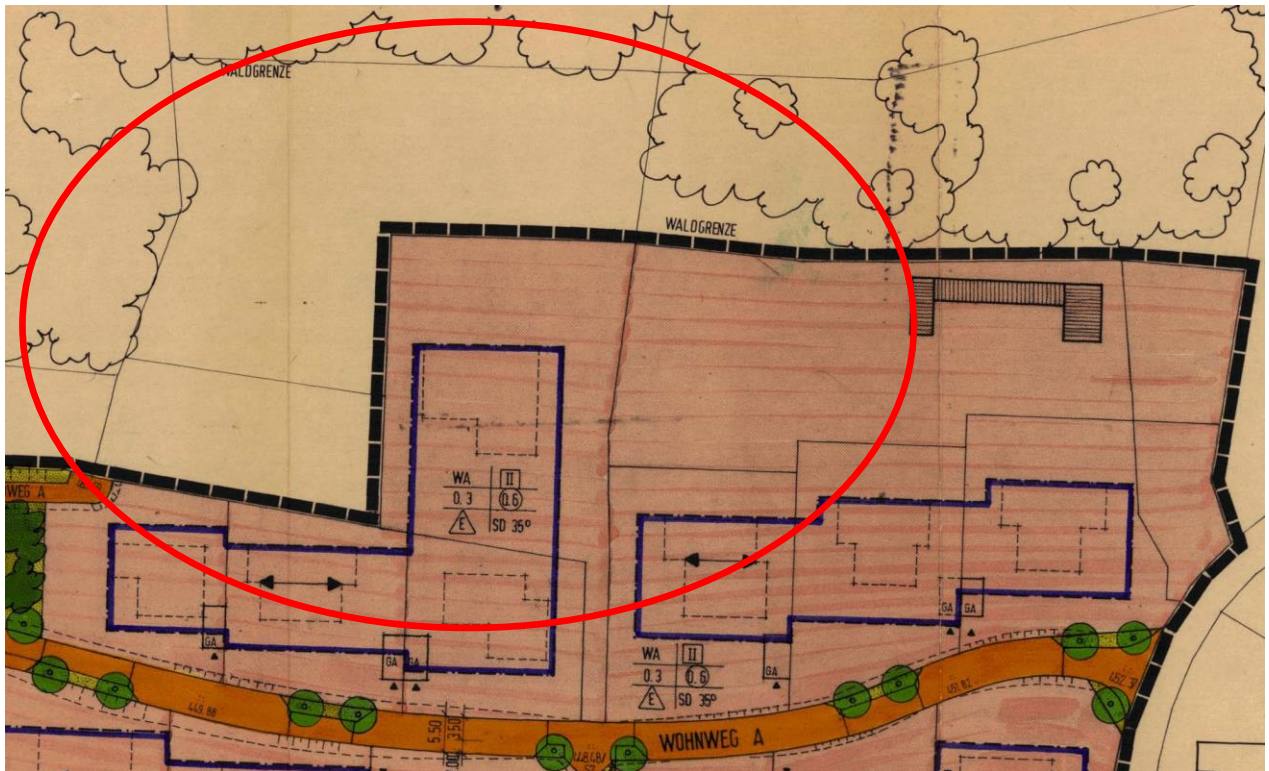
Ausschnitt Bebauungsplan „Hochweg“ (1990), Plangebiet rot umrandet, unmaßstäblich
